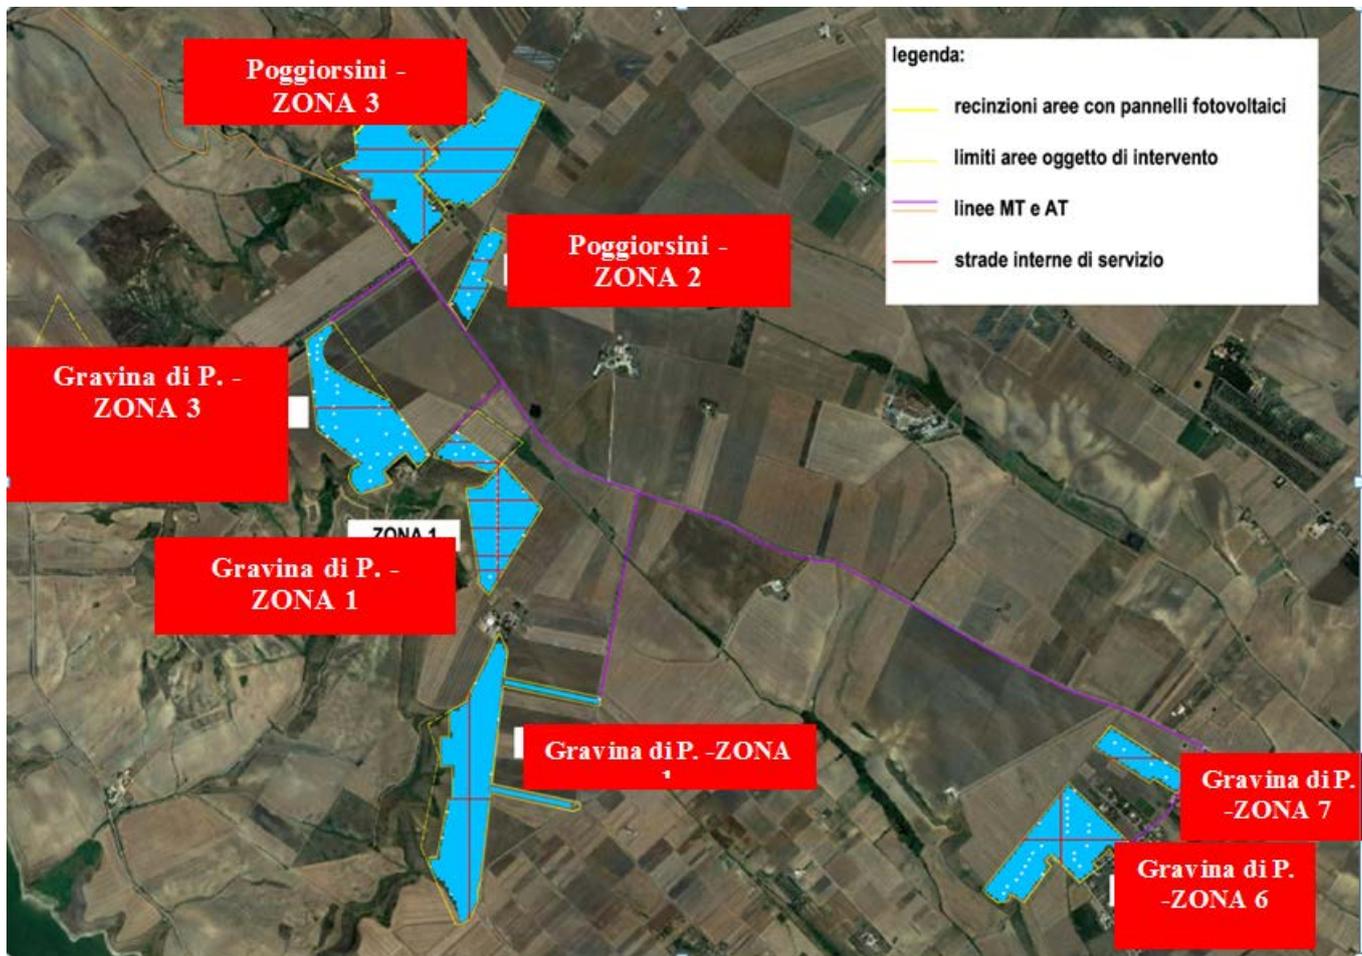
Stato di fatto dell'area di progetto su ortofoto
